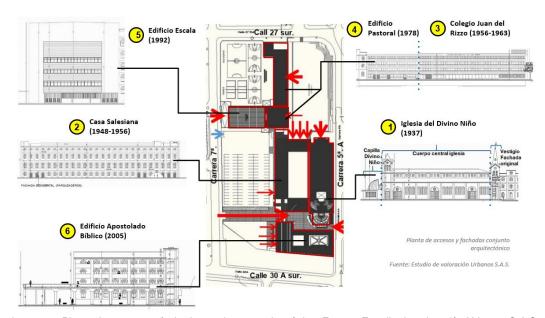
Planta de accesos y fachadas conjunto arquitectónico. Fuente: Estudio de valoración Urbanos S.A.S.
